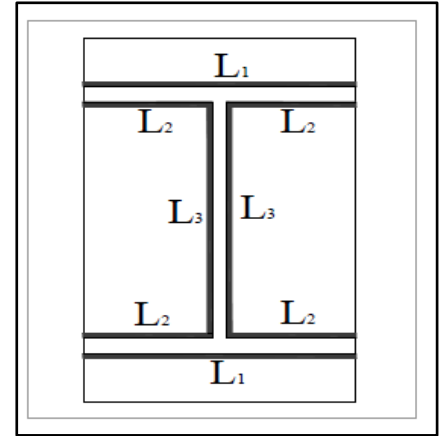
Assemblage soudé poutre-platine.
